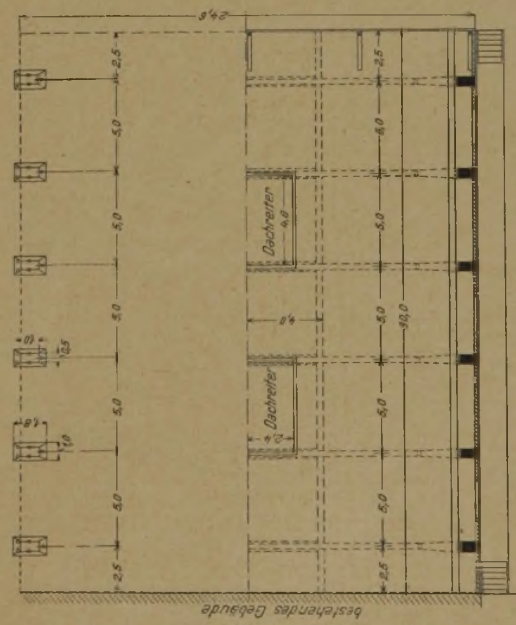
Grundriß des Hallenbaues. (1 : 400.)
